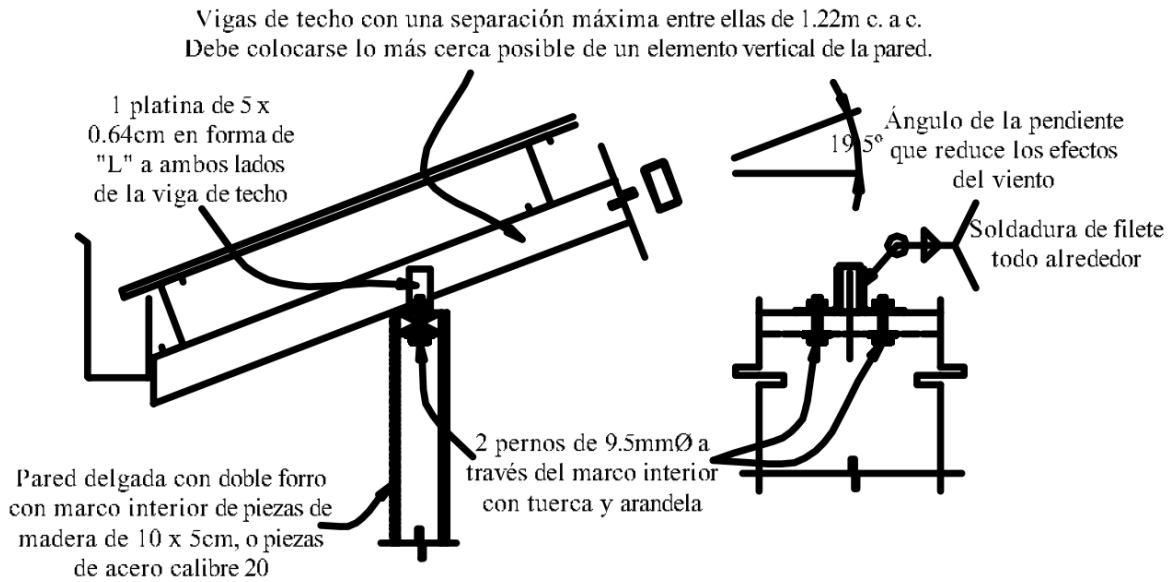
Detalle de apoyo de viga de techo en pared tipo emparedado
